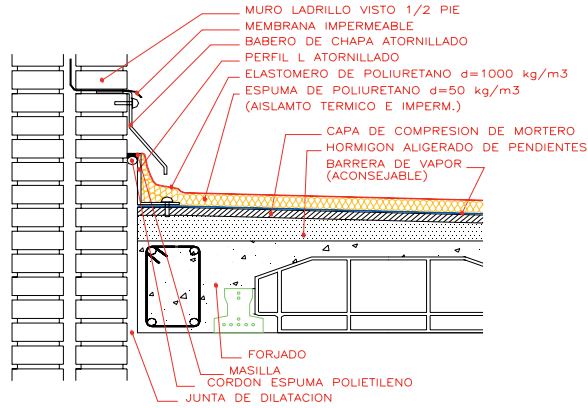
Detalle de encuentro con elemento estructural de soporte con dilatación libre.
